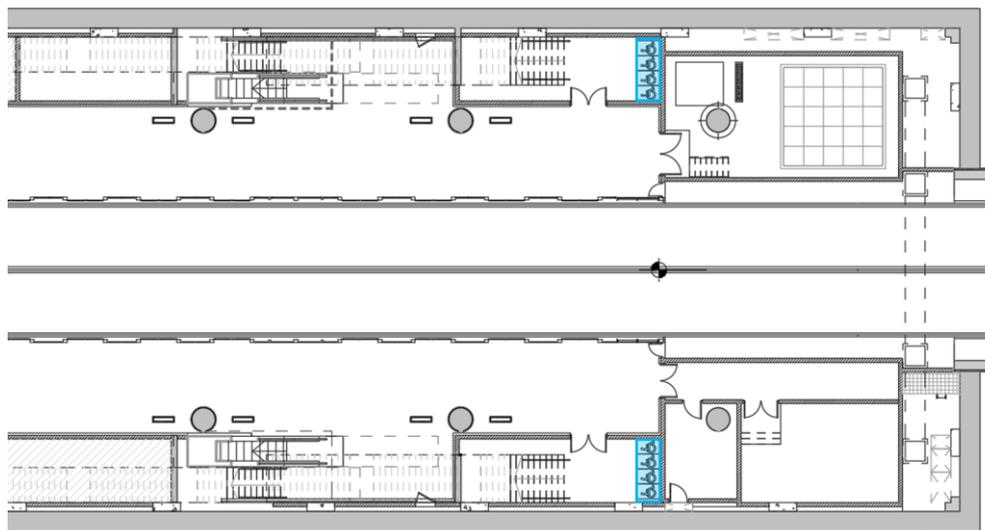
Zoom de lado este de planta de andén. Ubicación de PMR
